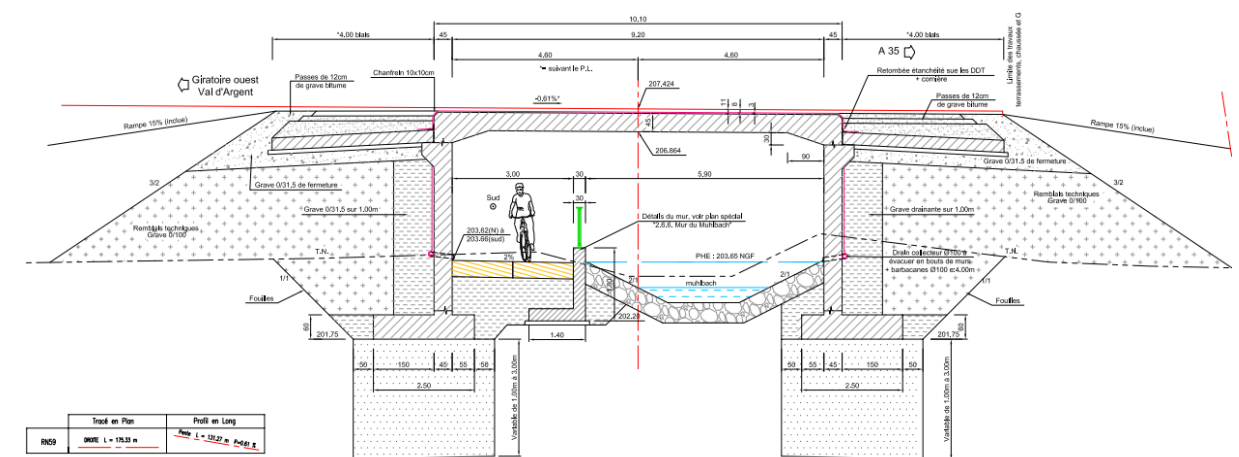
Coupe transversale de l'ouvrage OA1ter
